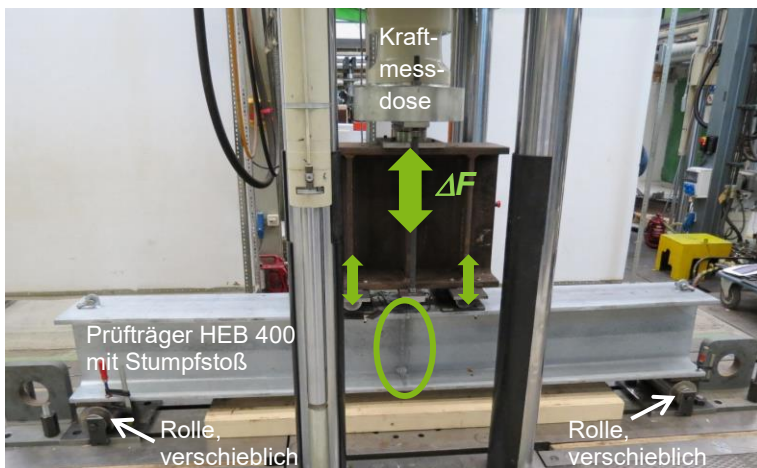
Versuchsaufbau Stumpfstoß eines Walzprofils
